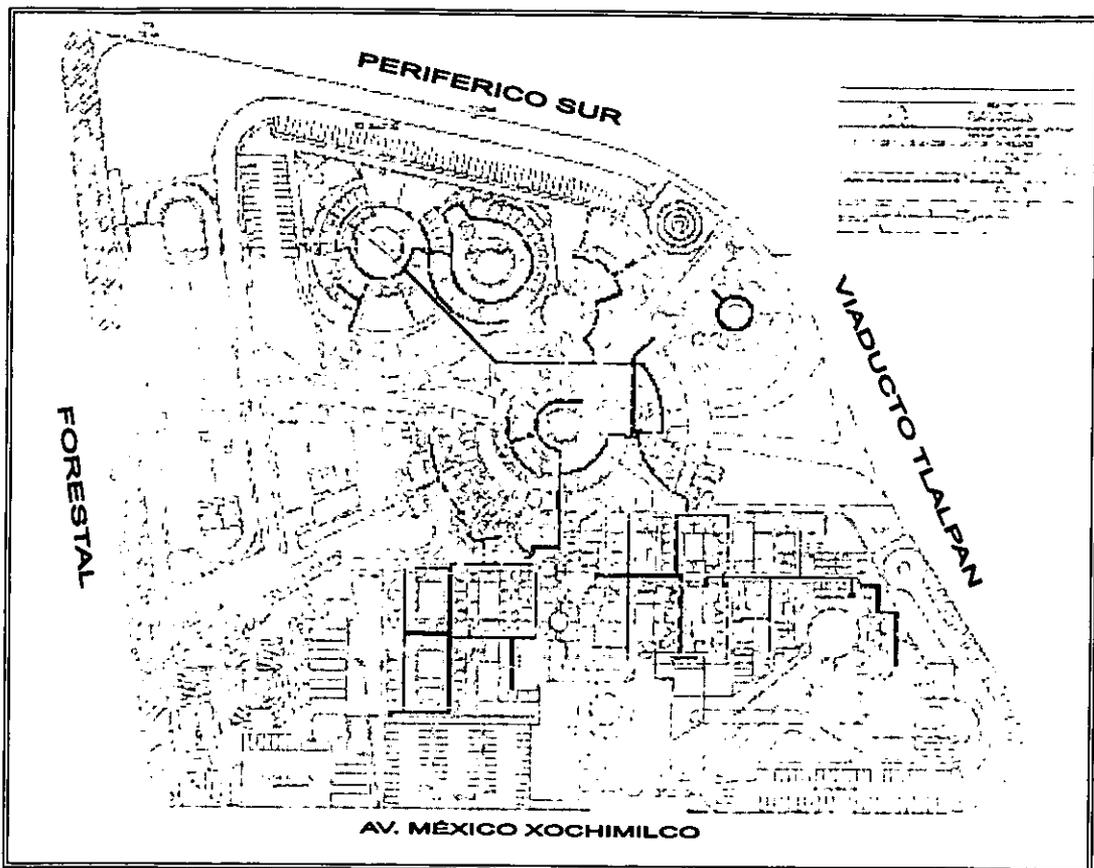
Diagrama de la charola principal de cableado estructurado distribuido en la Planta Baja de conjunto del Centro Nacional de Rehabilitación.
